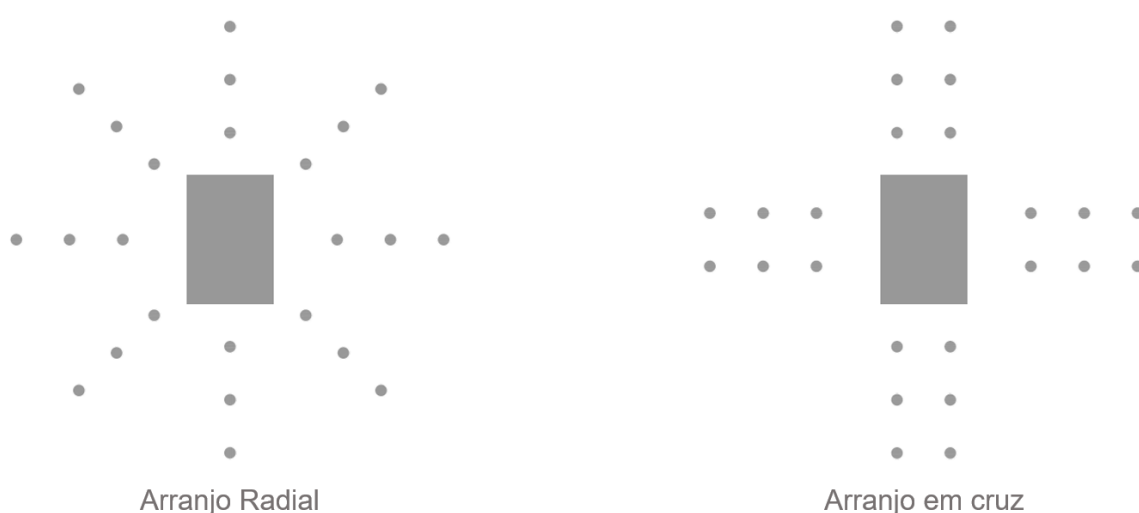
Tipos de armaduras de cisalhamento para lajes planas
